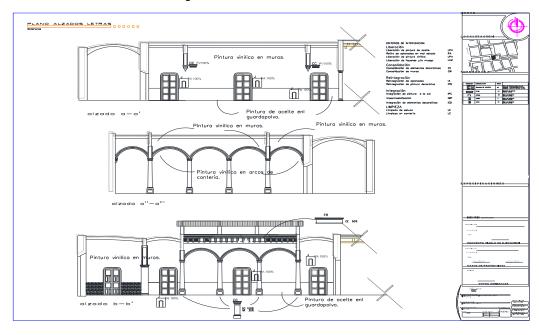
Planta de deterioros en Alzado. Eloísa Galván González.2016.
